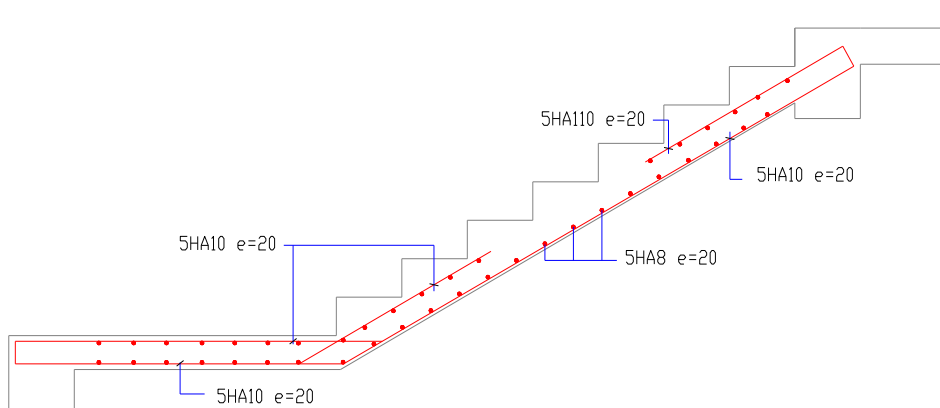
Schéma de ferrailage de l'escalier type 1 (niveau sous-sols).
